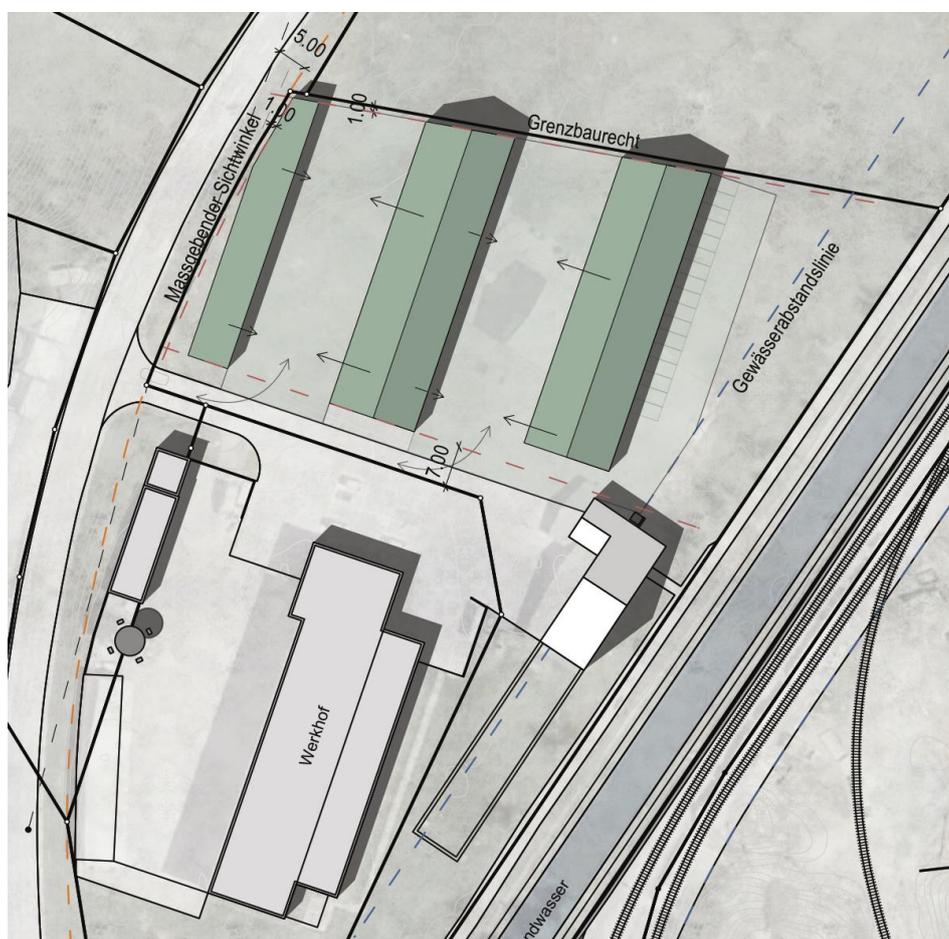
, Bauungs- und Erschliessungsstudie, Variante 1, Situation
